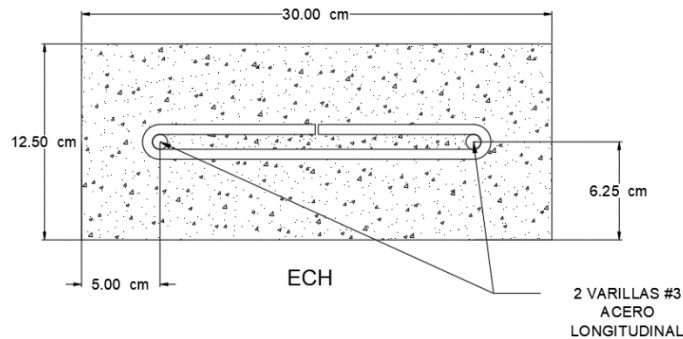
Sección Transversal Elemento confinante horizontal – Acero Longitudinal– Modelo III
